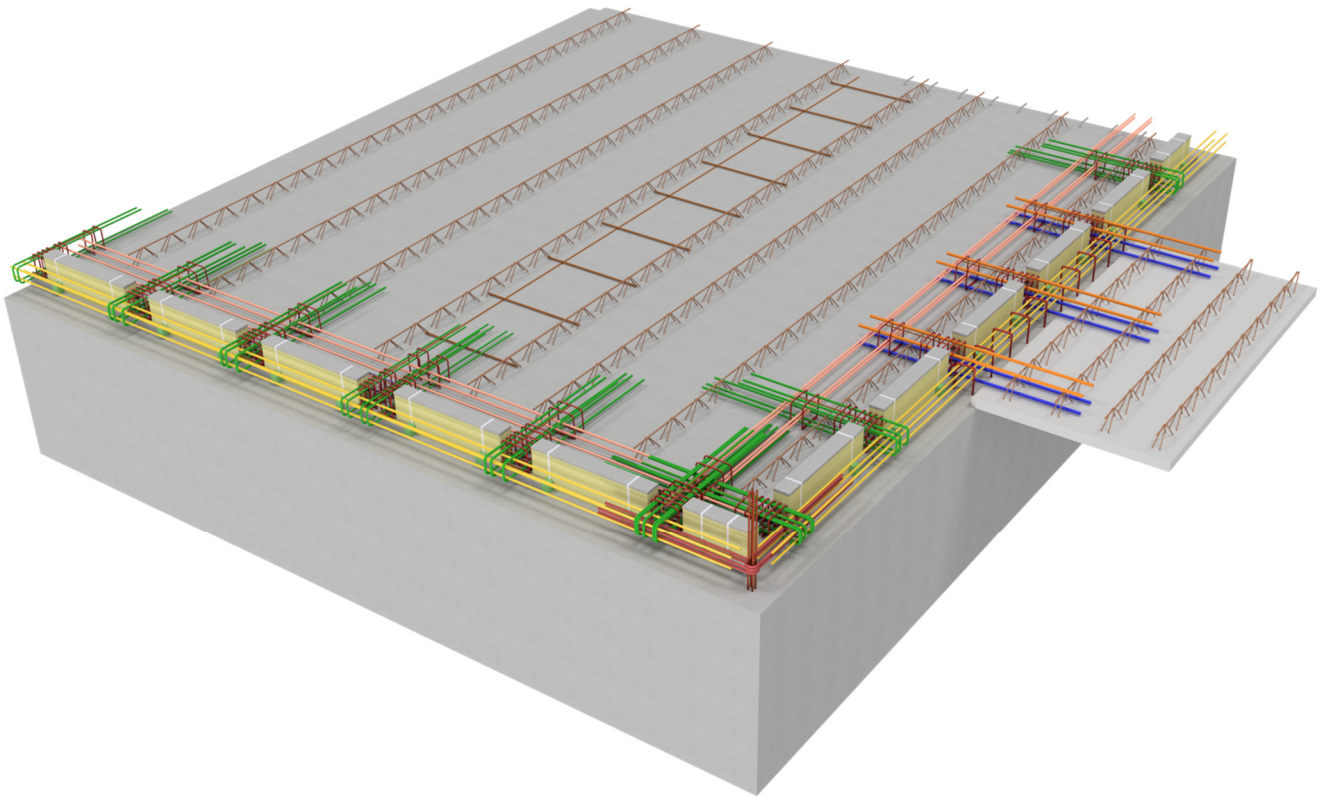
Représentation d'un angle de bâtiment et d'un balcon en prolongement du plancher
